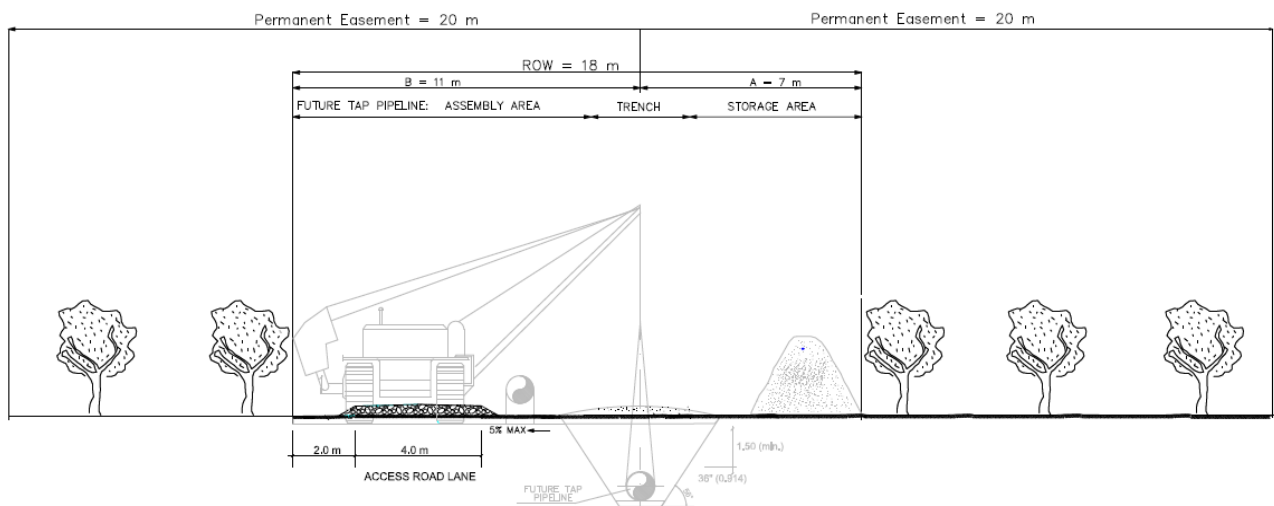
Strada di accesso (sezione tipo all'interno della pista di lavoro)
